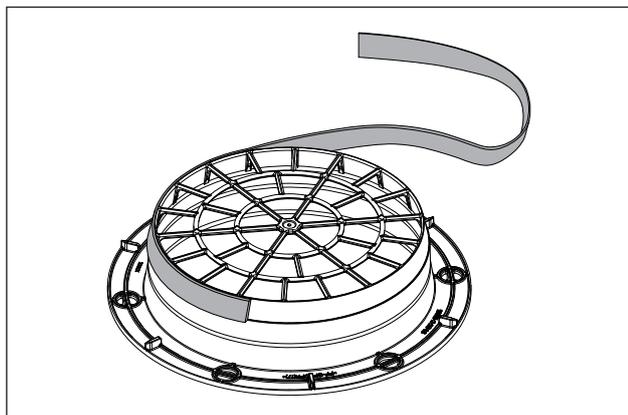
Posición de la cinta selladora para el montaje con tubo redondo
